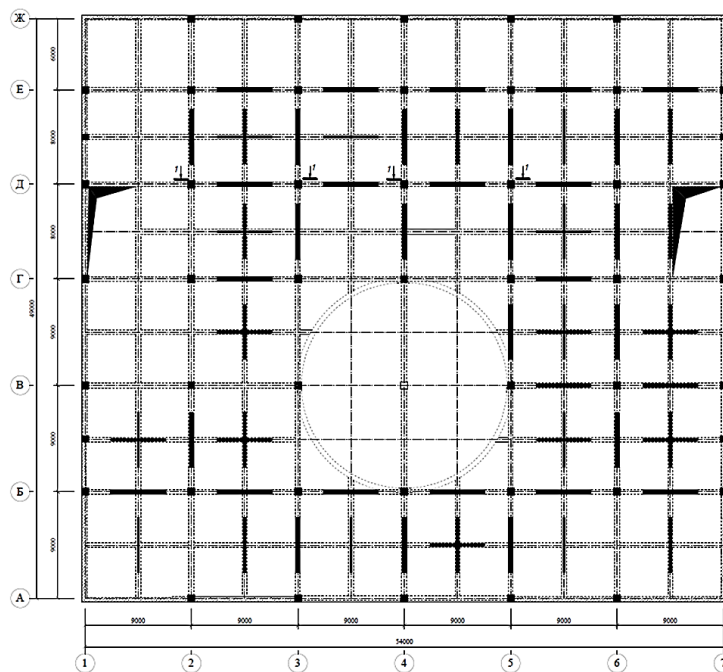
Схема усиления ригелей перекрытия на отм. +5.100 подземного здания лентами ламината
